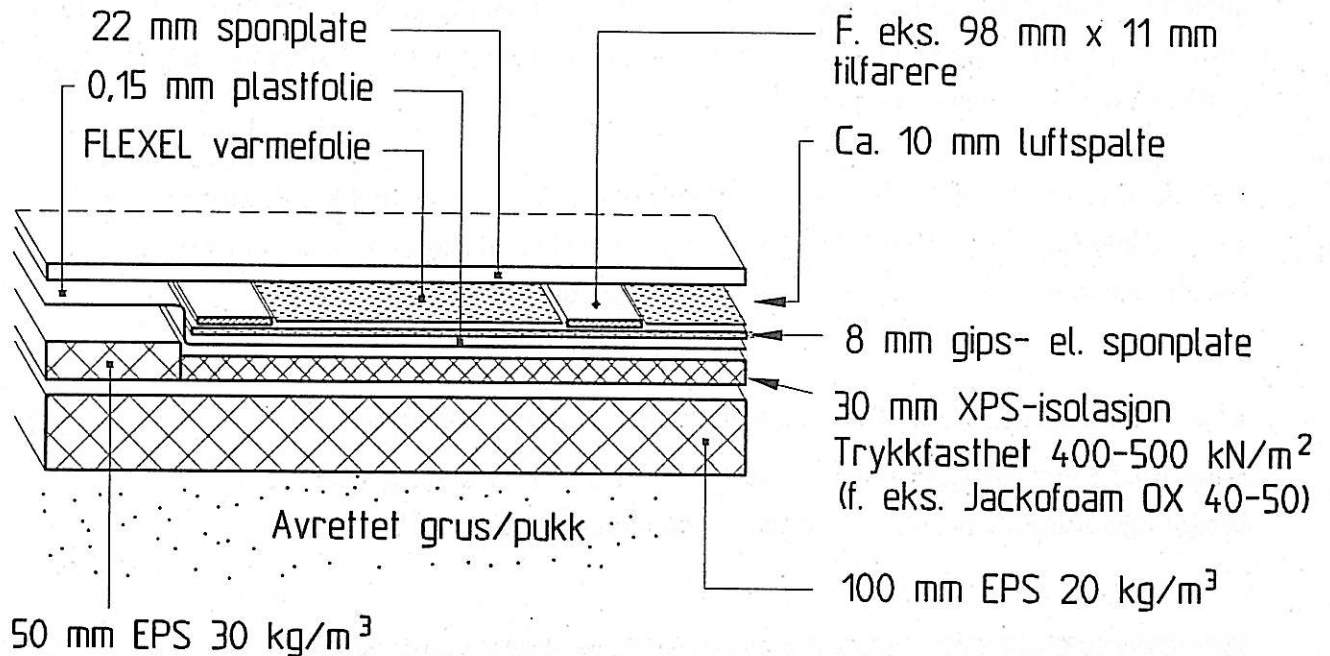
a. Lett gulvkonstruksjon med gulvvarme
